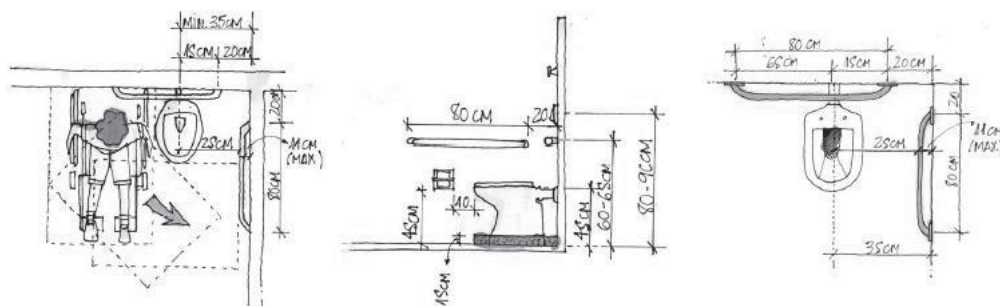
Vista superior e lateral para instalação sanitária acessível.
